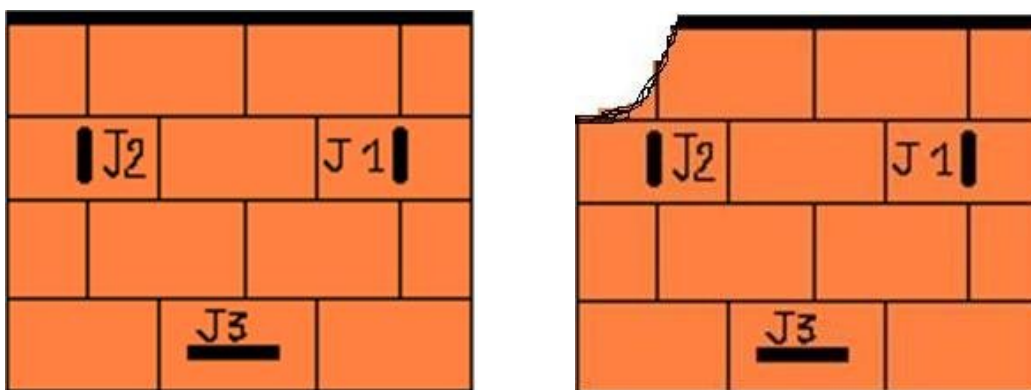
Emplacement des jauges pour l'essai n°11. Fig. IV.107. Rupture mur 12 trous de l'essai n°11.
